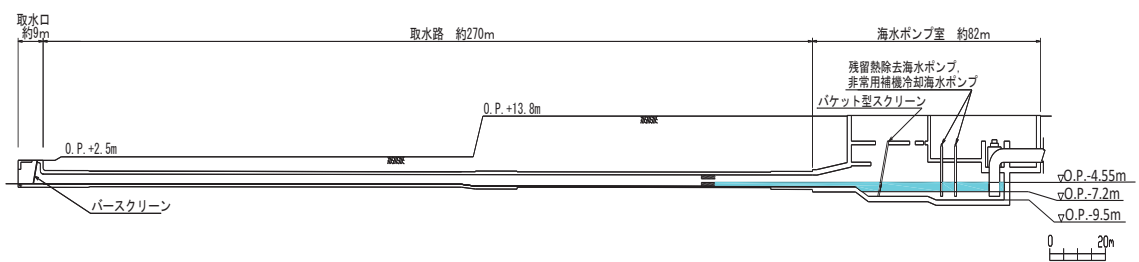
第1号機取水路～海水ポンプ室縦断面図
